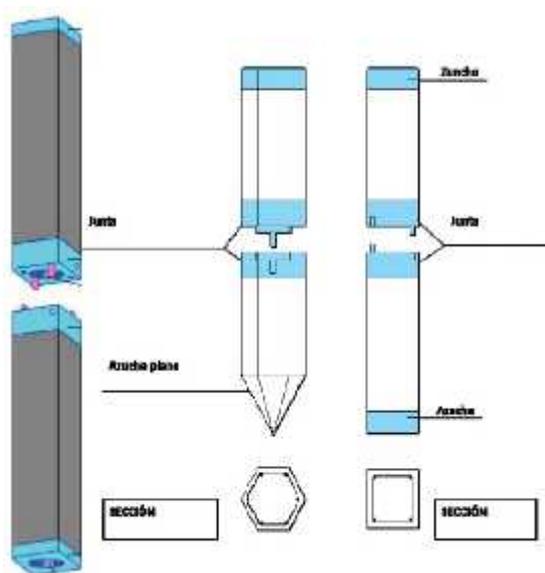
secciones de pilotes prefabricados unidos por juntas metálicas
